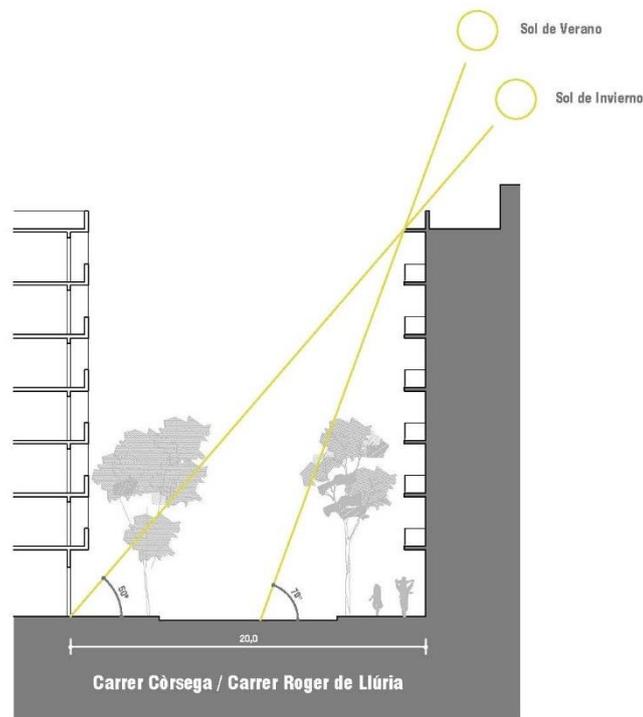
Sección transversal de las calles laterales. La sección tipo del eixample de 20m de ancho garantiza un buen asoleamiento de las fachadas. Fuente elaboración propia.
